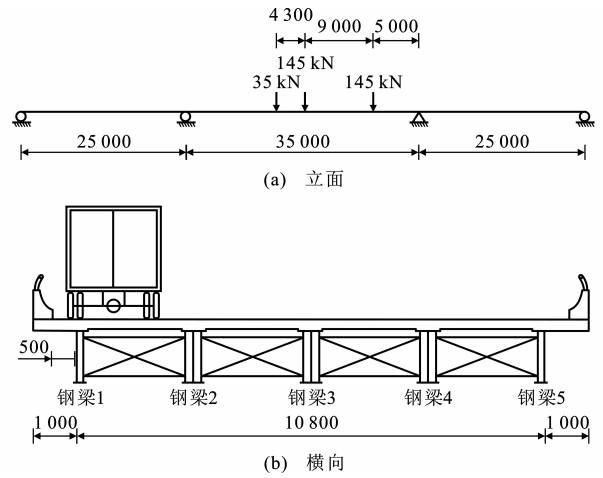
工况 1 荷载立面及横向布置 (单位: mm)
